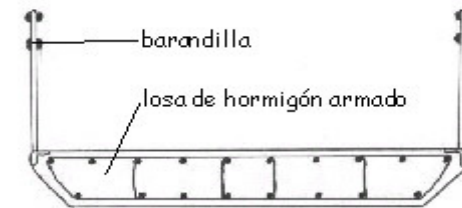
Sección transversal típico. Ingrid Raventós (2000).
